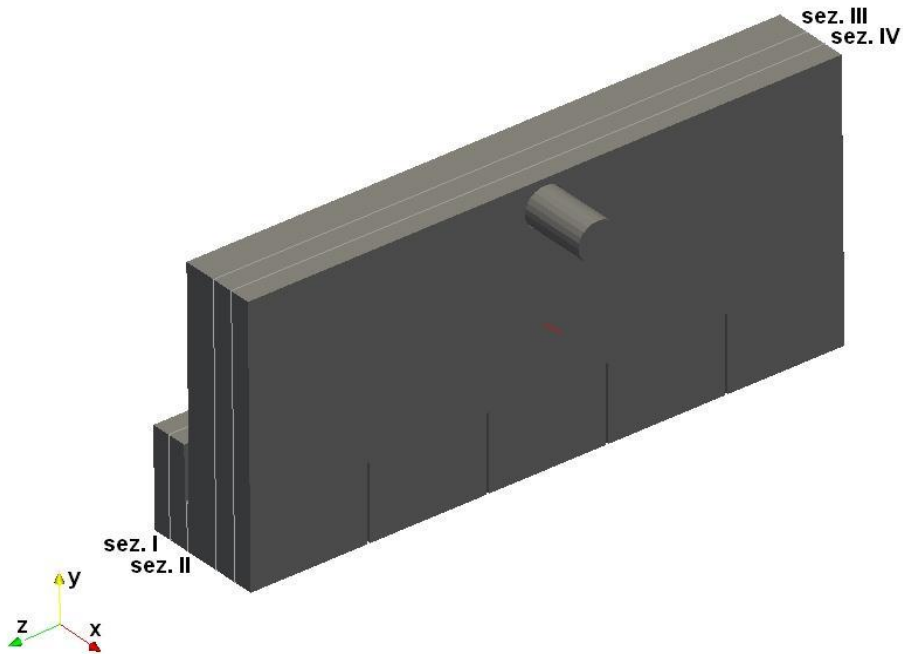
Modello geometrico con indicazione delle sezioni nel piano y-z – Vista 1
